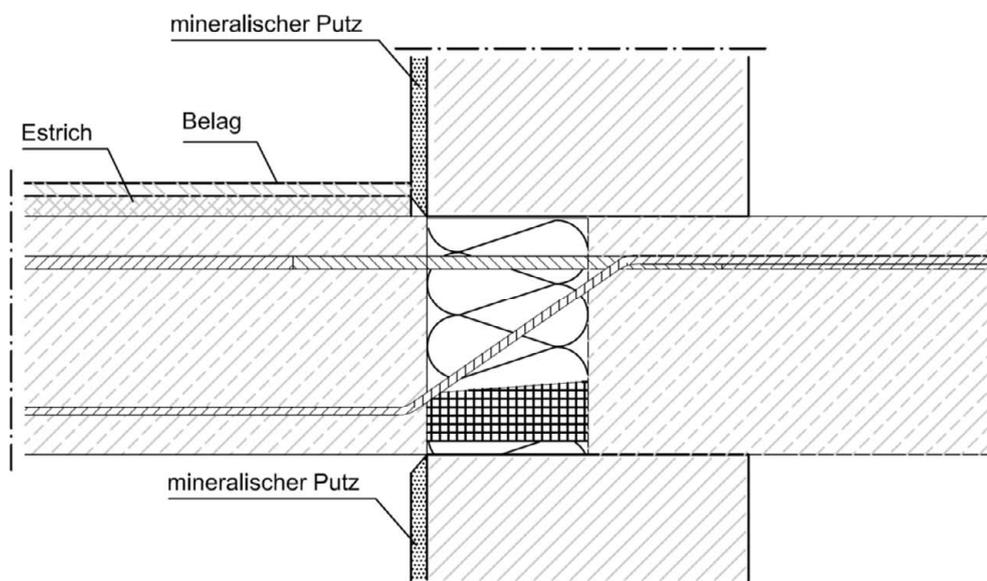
prinzipielle Ausführung mit eingeschlossener Fuge
